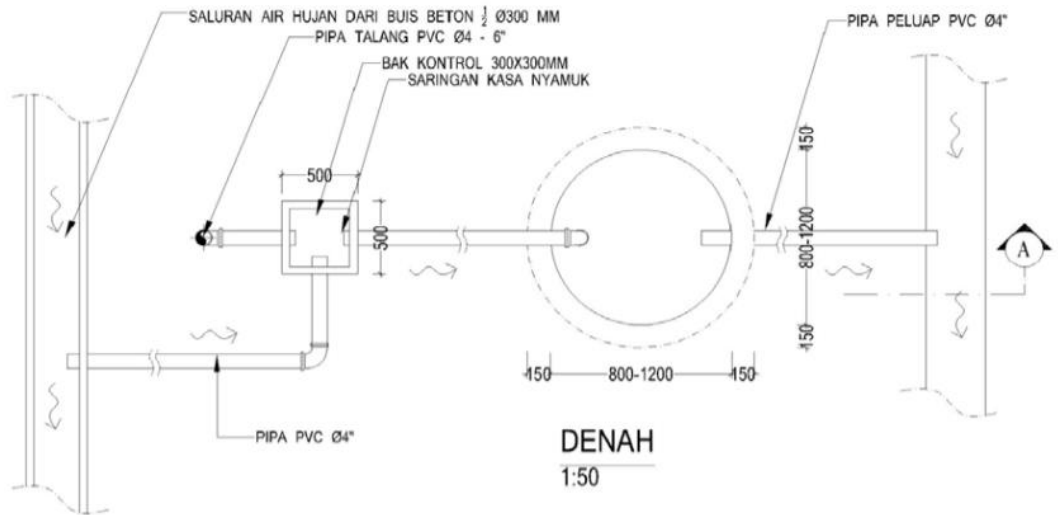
82 Contoh Gambar Konstruksi Sumur Resapan Beton Berpori
